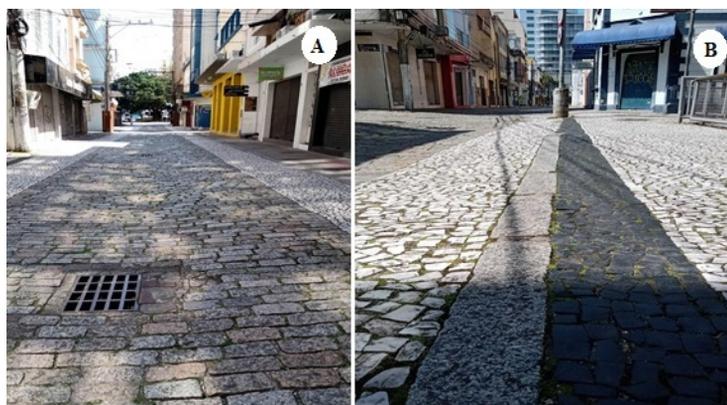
Pavimento em granito (A) e *petit pavé* com faixas em granito no Calçamento da Rua João Pinto (B). Fonte: Arquivo pessoal dos autores
